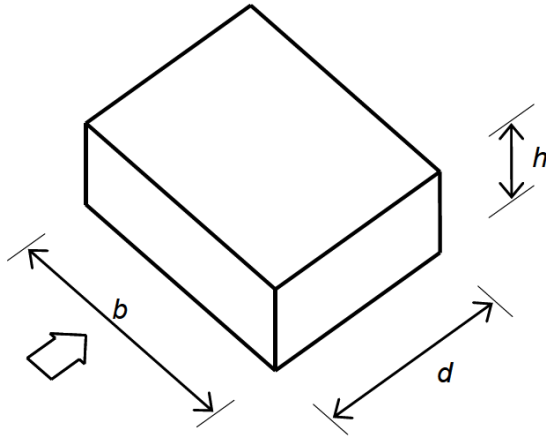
Parametri caratteristici di edifici a pianta rettangolare.
